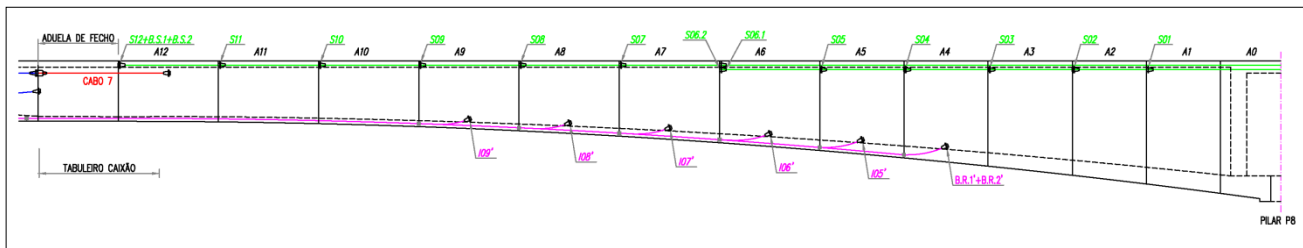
PRÉ-ESFORÇO TRANSVERSAL NA ZONA DOS PILARES DA PONTE DA MUXIMA SITUADOS NO RIO
